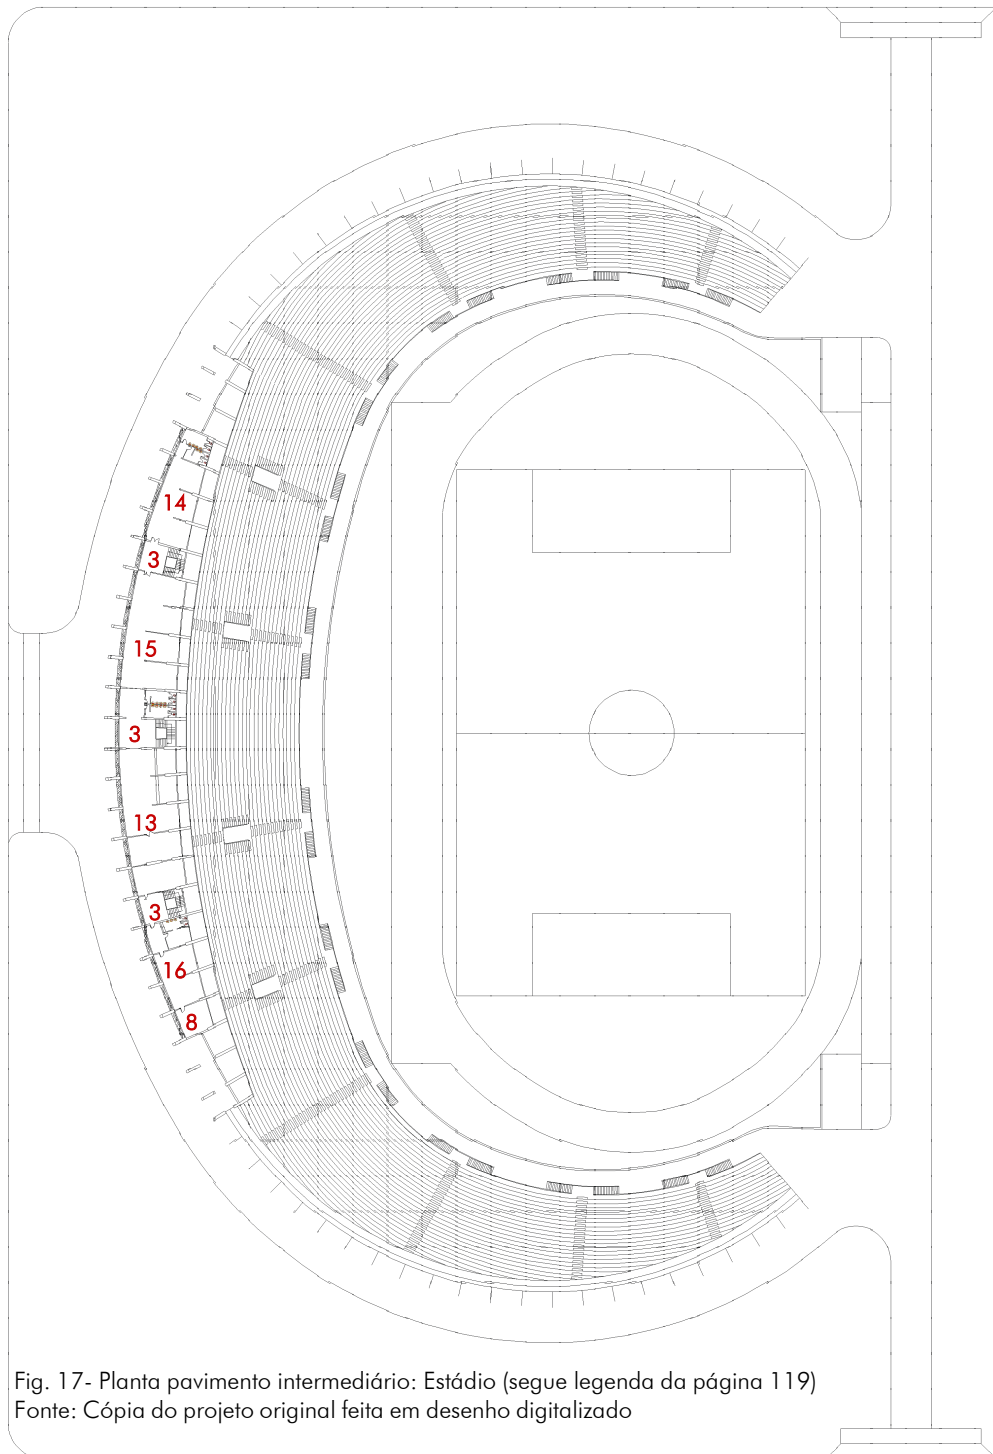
Planta pavimento intermediário: Estádio (segue legenda da página 119)
